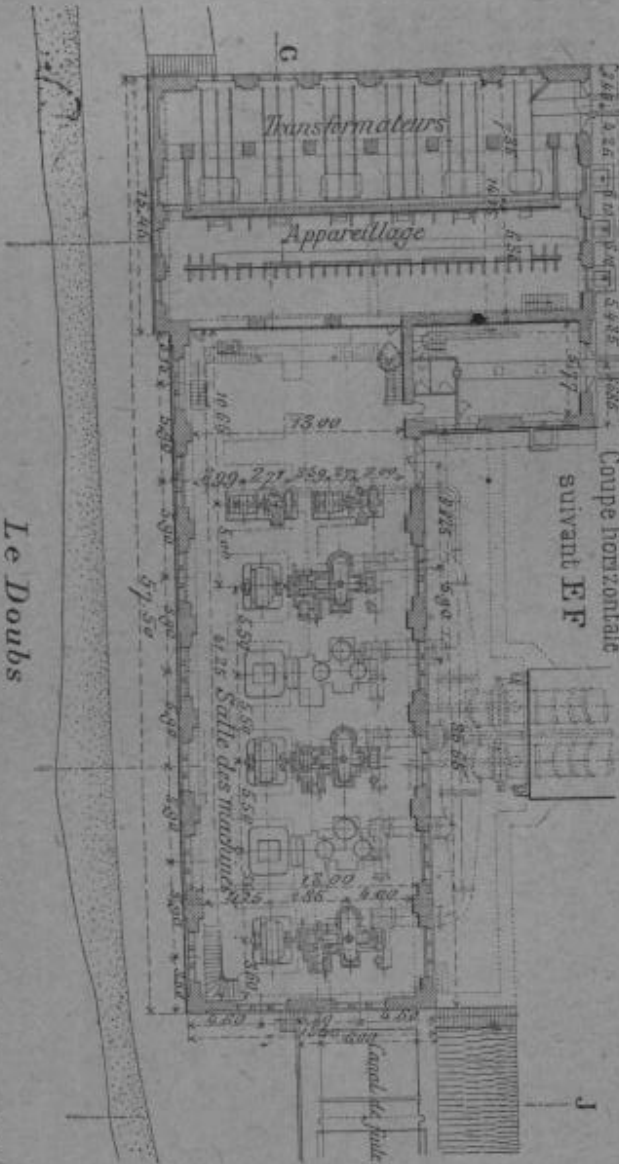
Usine du Refrain. Élévation et plan de l'usine génératrice.
